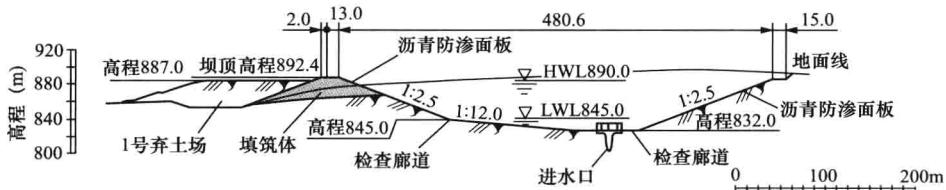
京极抽水蓄能电站上水库剖面图 (单位: mm)
